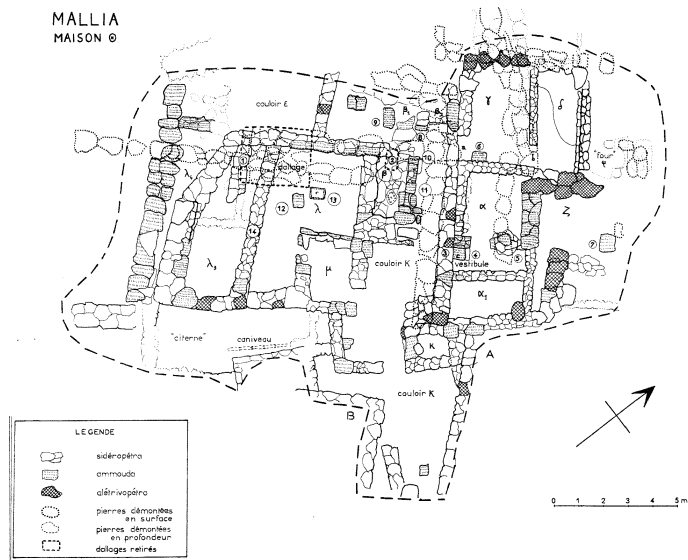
Grundrißplan des Gebäudes Θ mit Raum λ, Malia.
